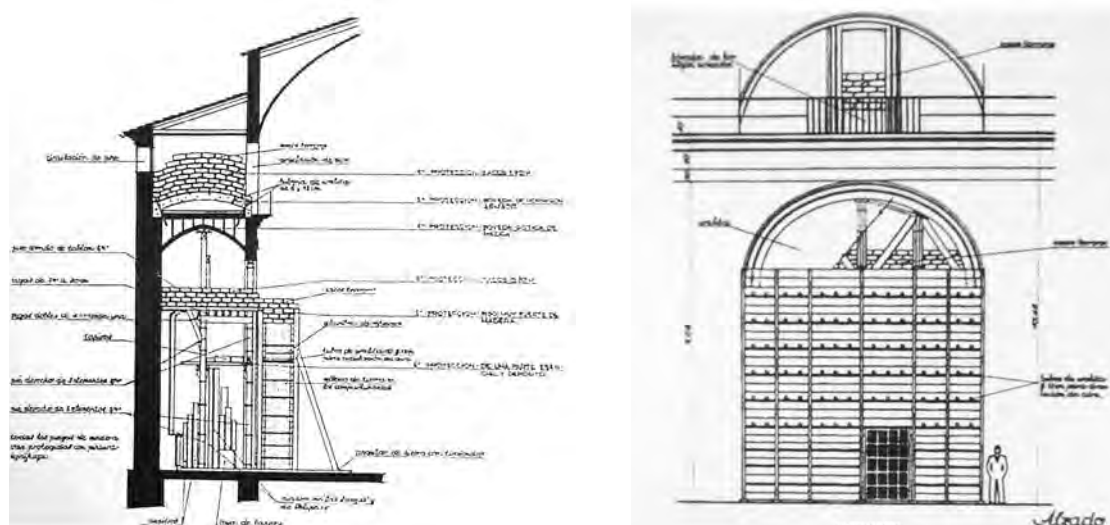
Sección y alzado de una de las capillas del Colegio en 1937.
